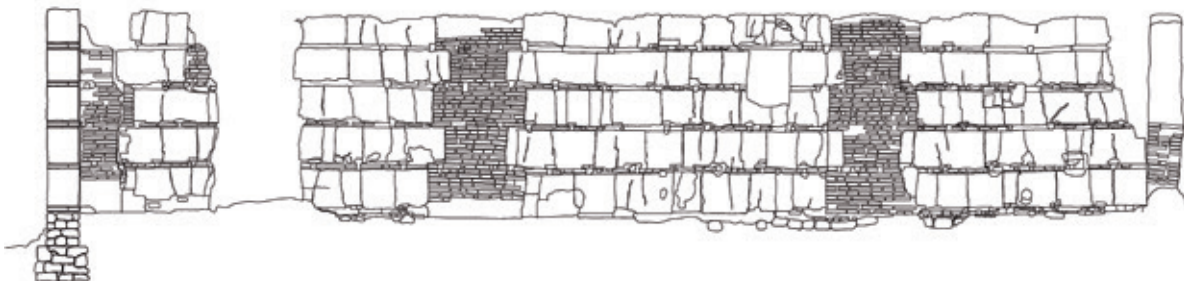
Corte longitudinal. Levantamiento de la iglesia de San Pedro de Iguaque-Boyacá construida en tapia rafada con adobe. Autor: A. Chica S., 2009.
